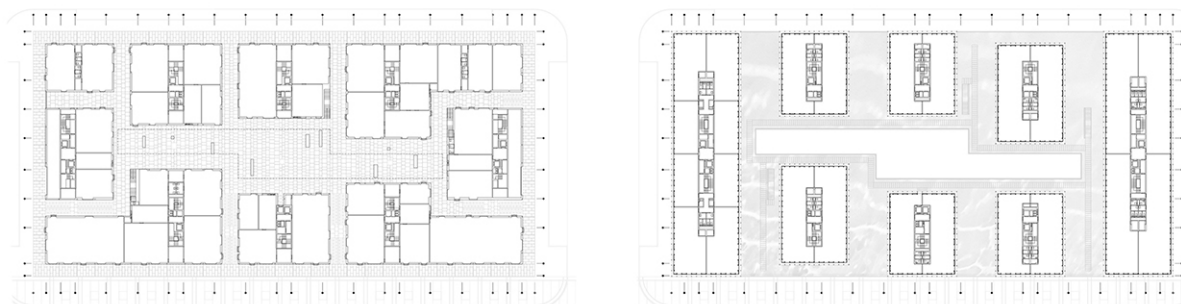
Planta do piso de Assentamento | Planta do piso Tipo. (Esc. 1:2000)
